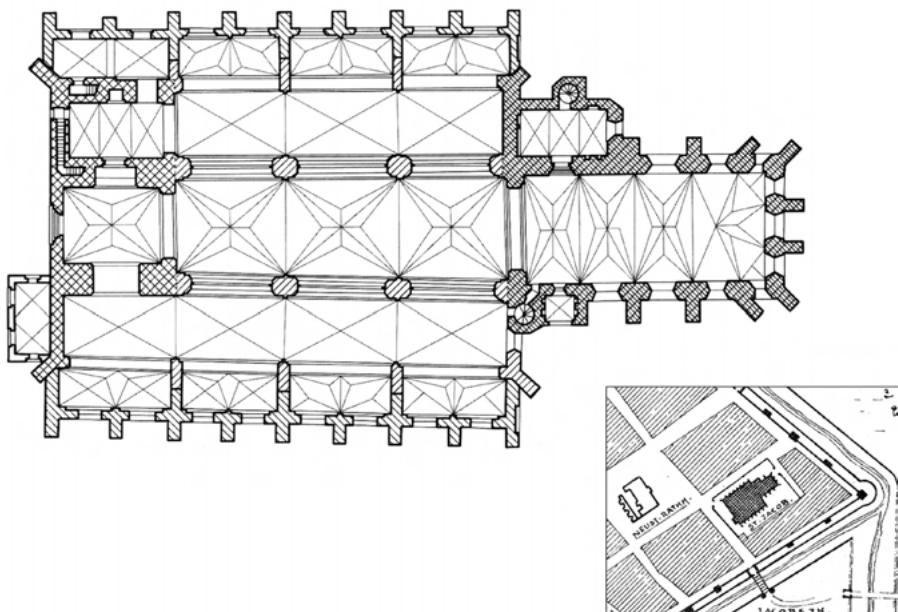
Thorn, St. Jakob, Grundriss und Stadtplanausschnitt mit Lage im Kirchhof
